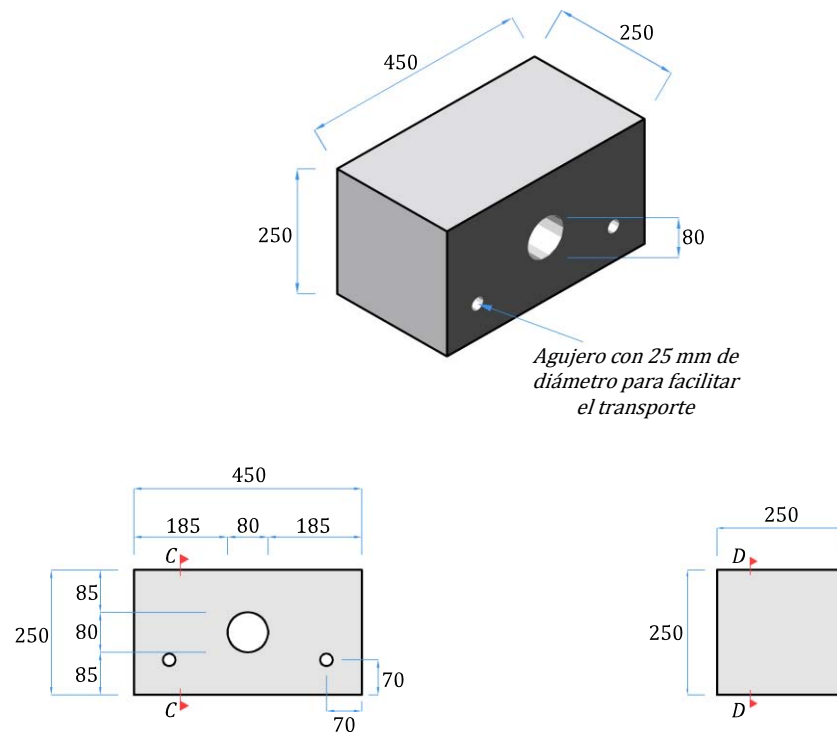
Dimensiones del bloque de extremidad: a) vista isométrica; b) alzado frontal y alzado lateral (medidas en mm)
